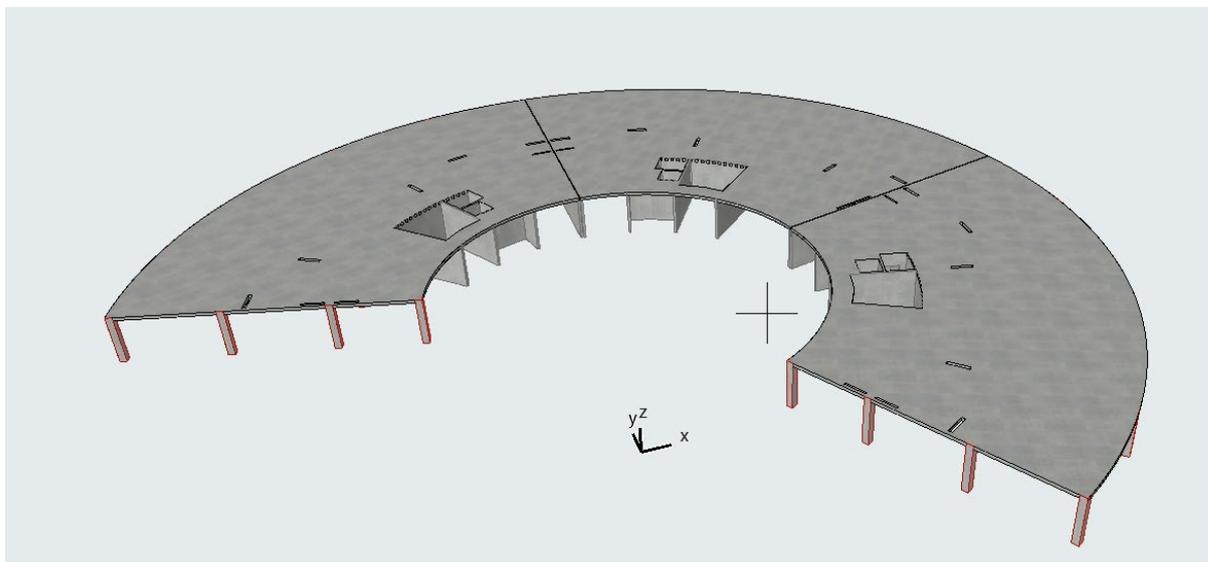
Импортируемая модель перекрытия типового этажа
